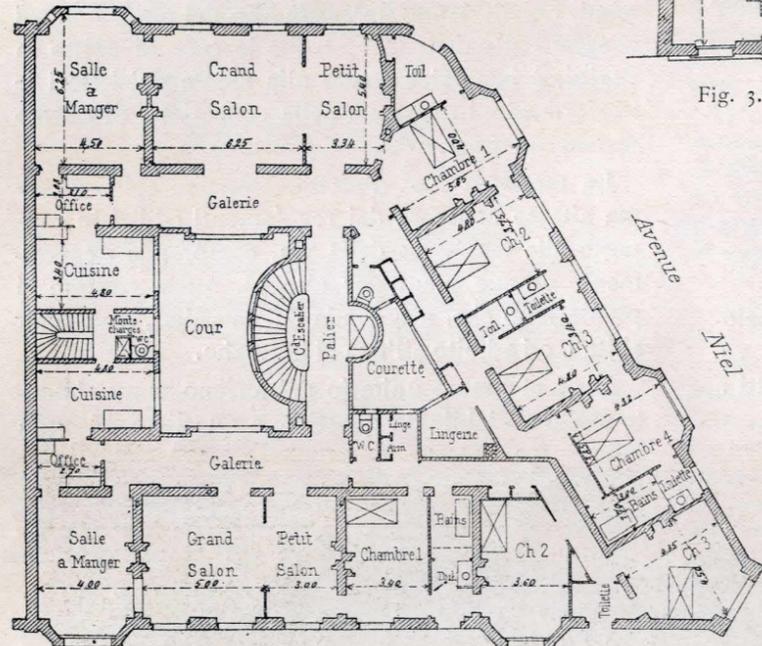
Pianta dell'edificio dell'Avenue Niel.
